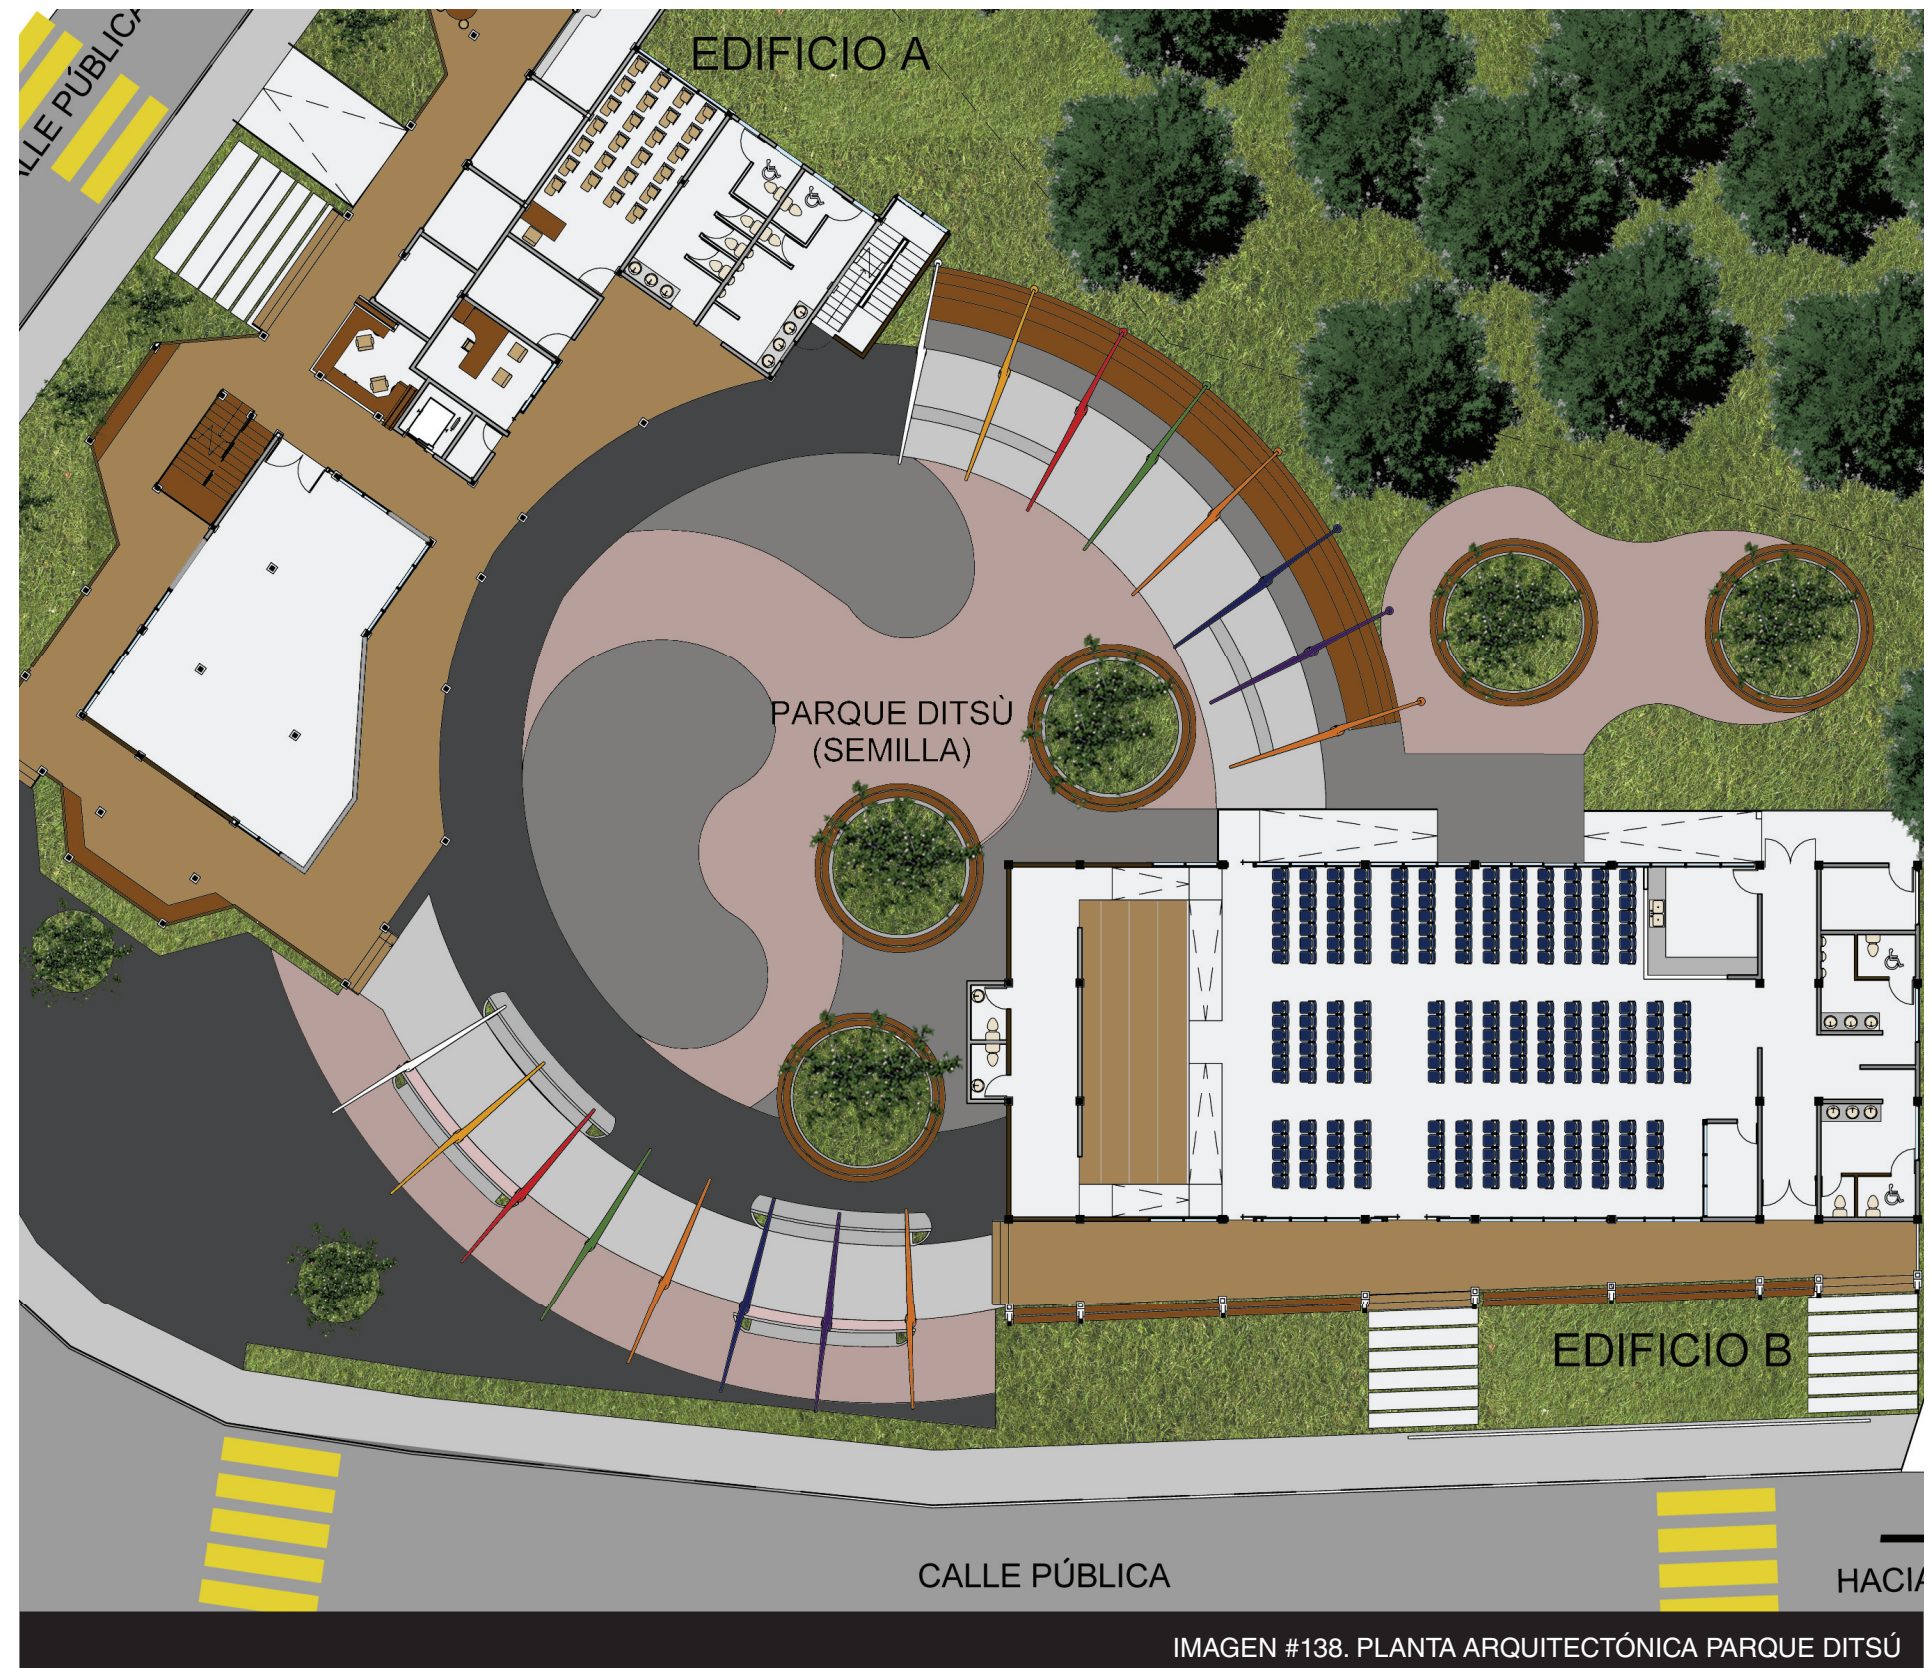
PLANTA ARQUITECTÓNICA PARQUE DITSÚ
